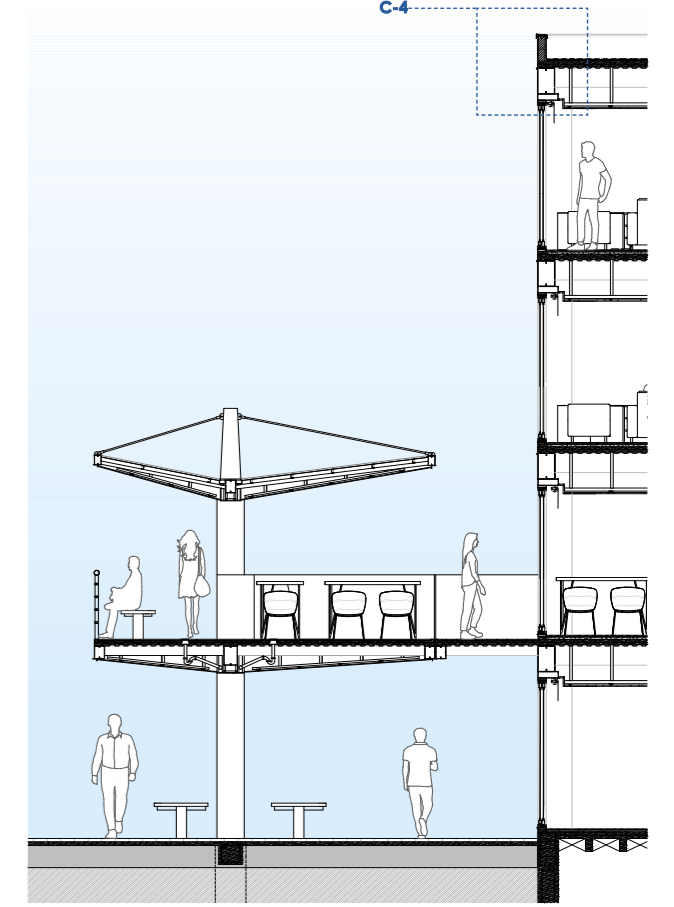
Sección Constructiva S-1-Detalle C-4. Fuente: Elaboración propia (2026)
